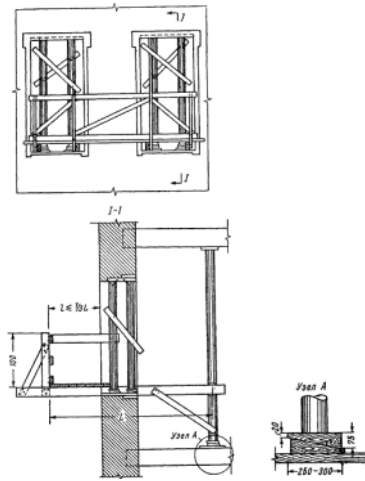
Схема устройства временных креплений перемычек и устройства выпускных лесов при перекладке простенков
